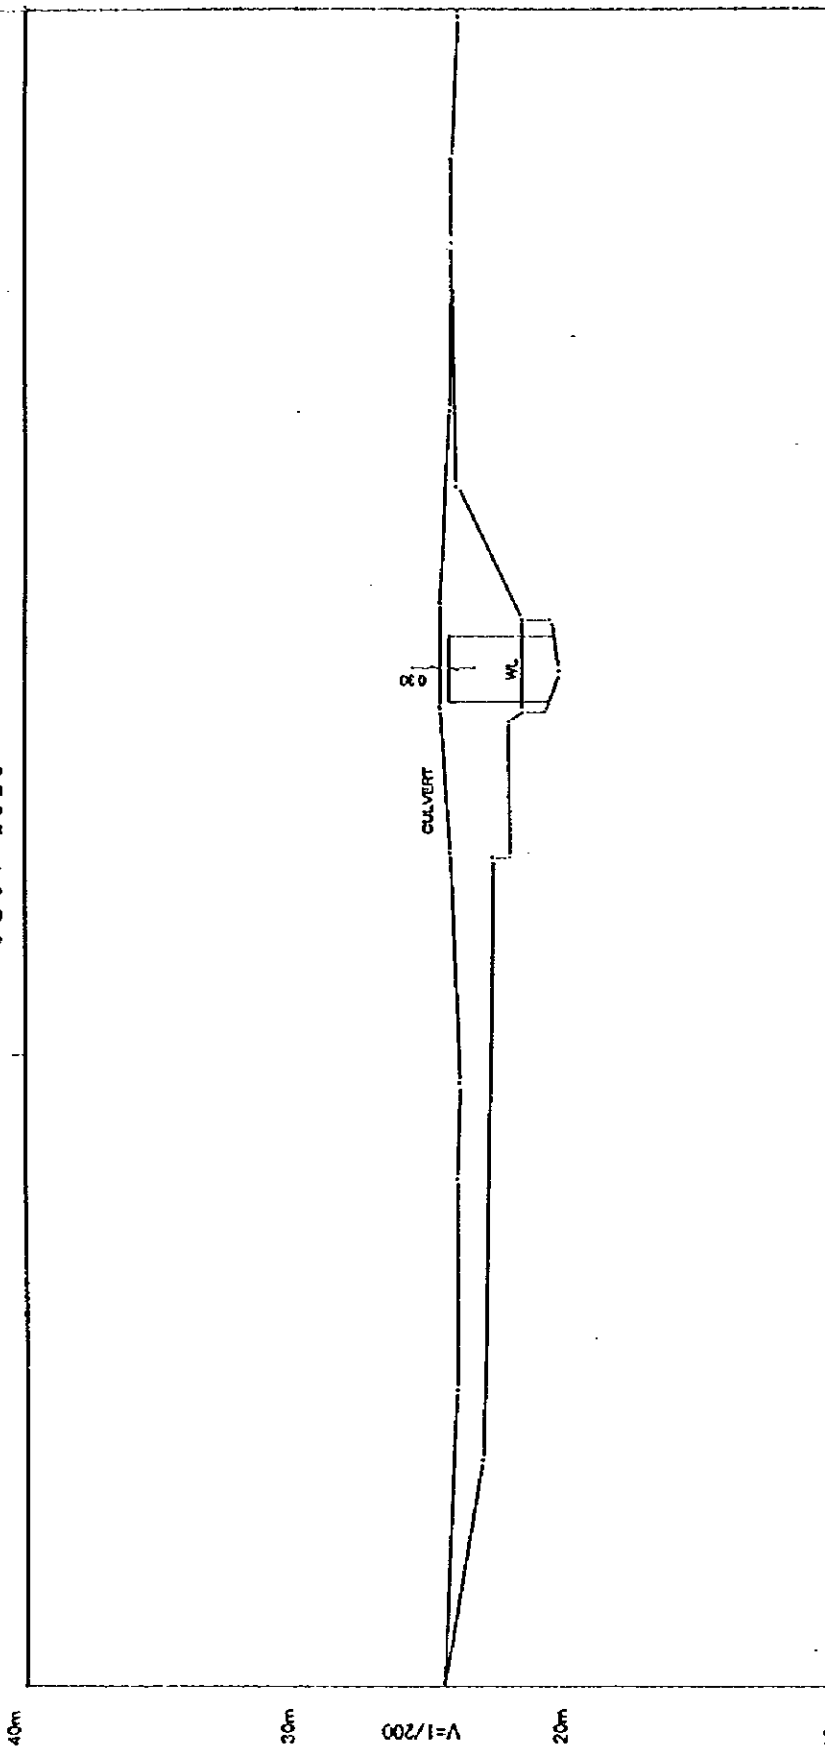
ALCANTARILLADO PARA DRENAJE EN EL JOCOTAL(1/2)
